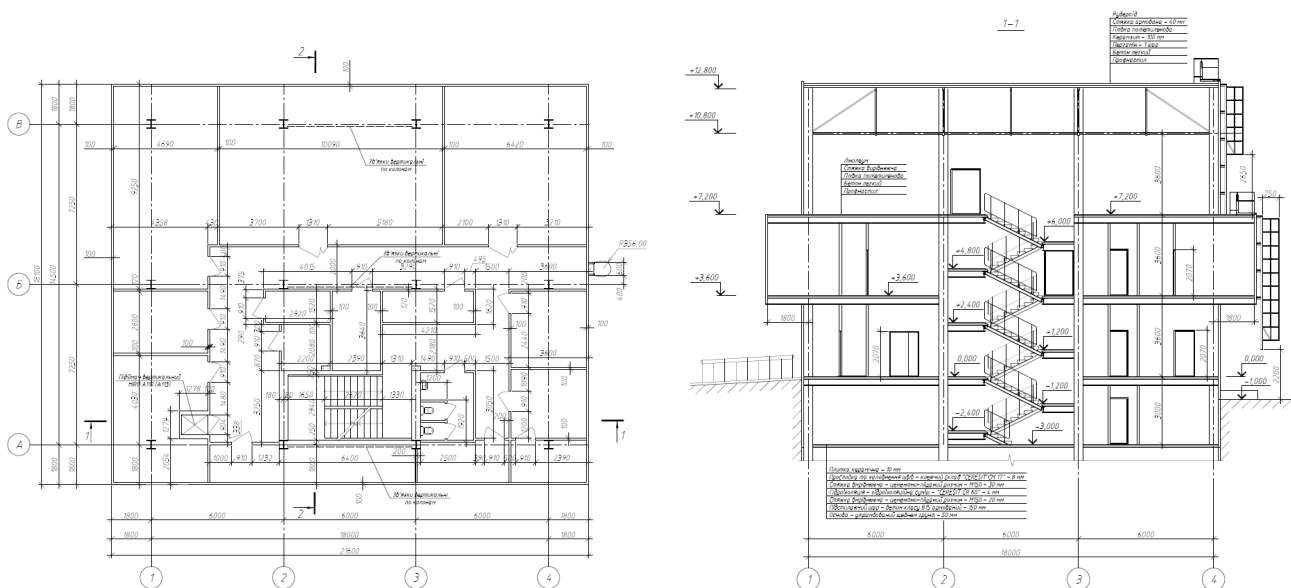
План поверху та поперечний розріз будівлі побутового центру.
